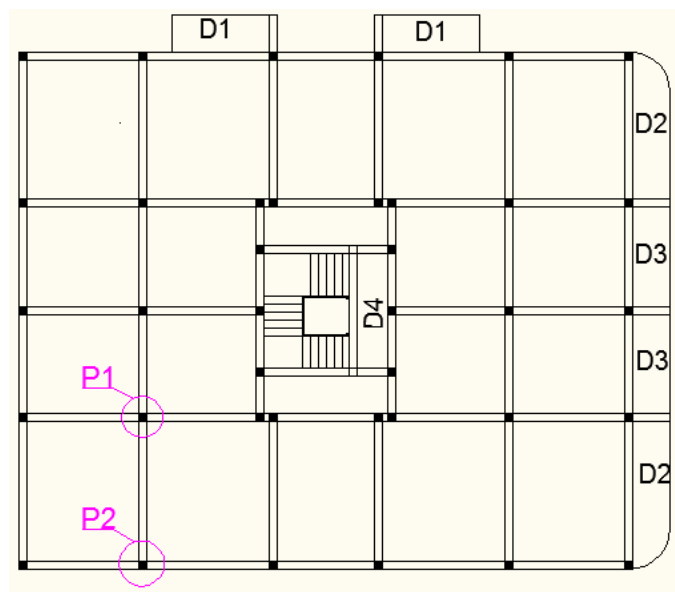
Schéma illustratif des différentes dalles et poteaux choisis pour le calcul
